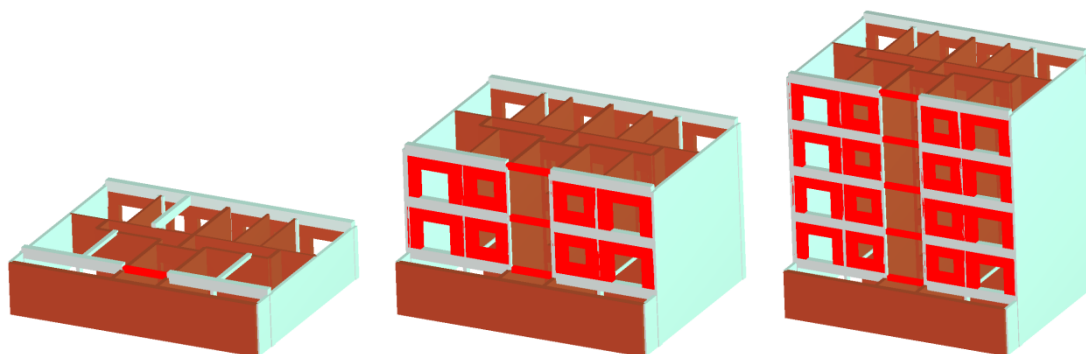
Esquema de introdução da viga de contraventamento ao nível do pavimento em cada piso, e do reboco armado na fachada principal, rés-do-chão (esq.), 2º piso (meio) e cobertura (dirt.).
